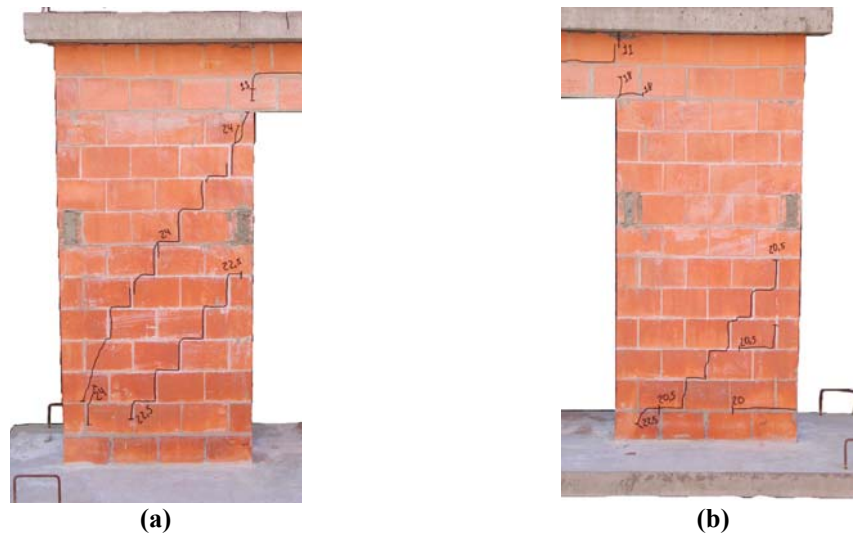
Fissuração das paredes do modelo PPCG2: (a) Parede P1 e (b) Parede P2.
